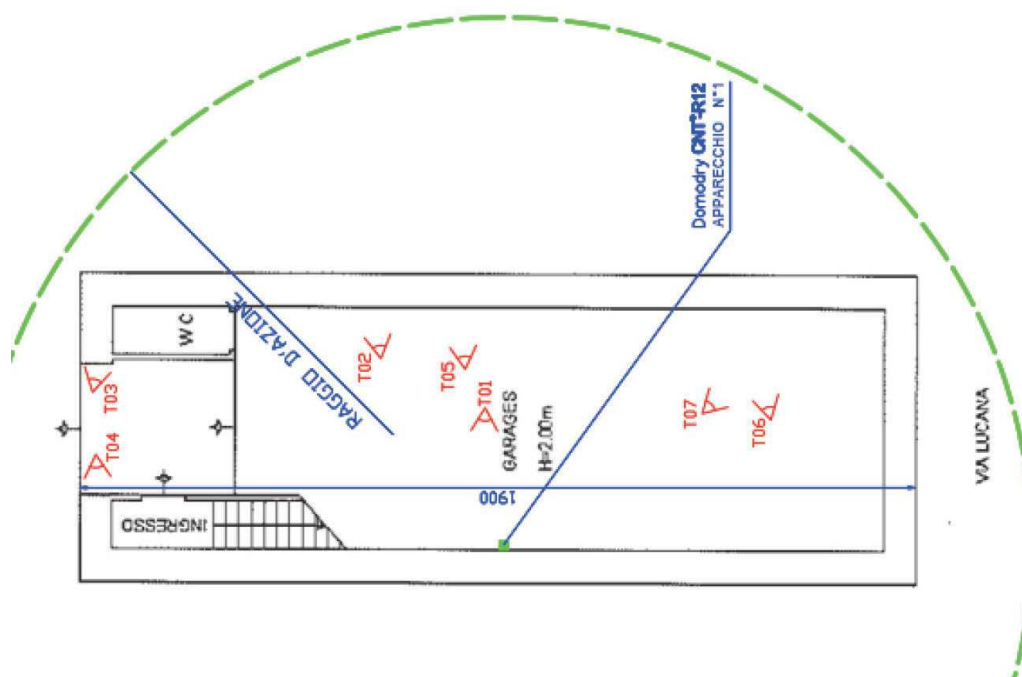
Abitazione privata nei Sassi di Matera: schema planimetrico impianto CNT
